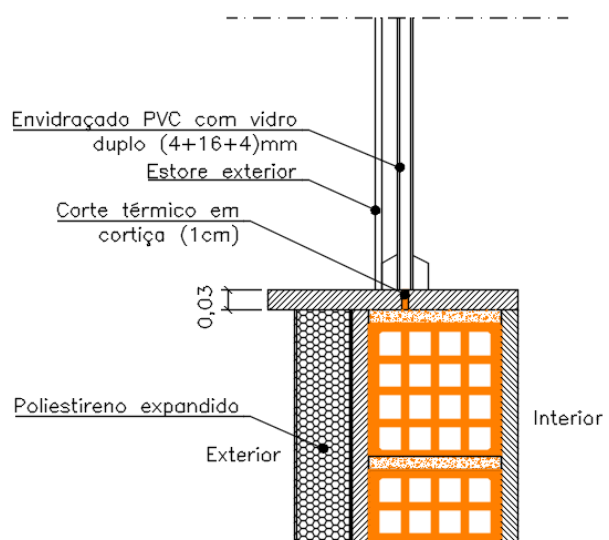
Pormenor construtivo peitoril e vão envidraçado
